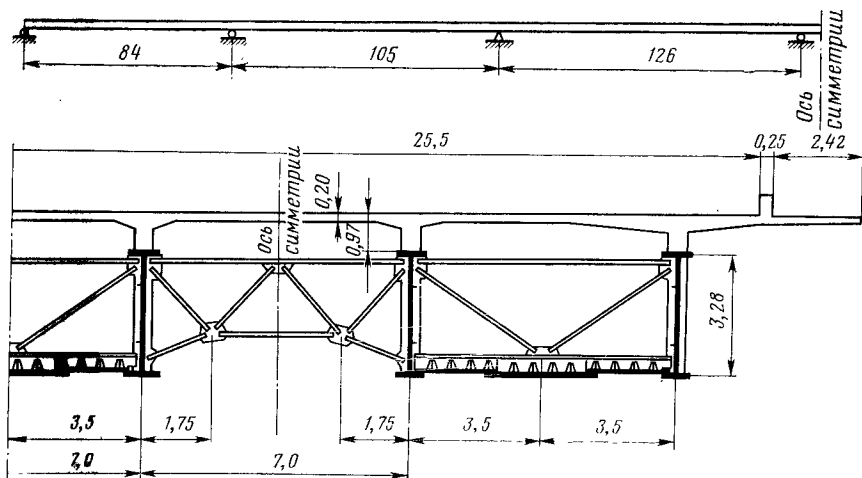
Схема и поперечный разрез сталежелезобетонного пролетного строения городского моста
